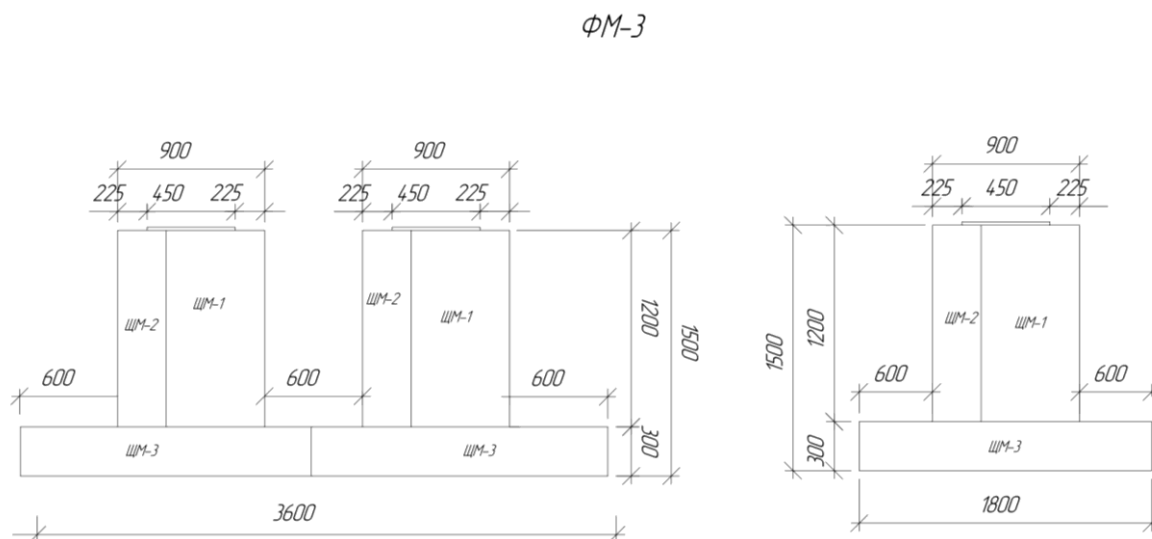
Расположение щитов опалубки для фундамента ФМ-3
